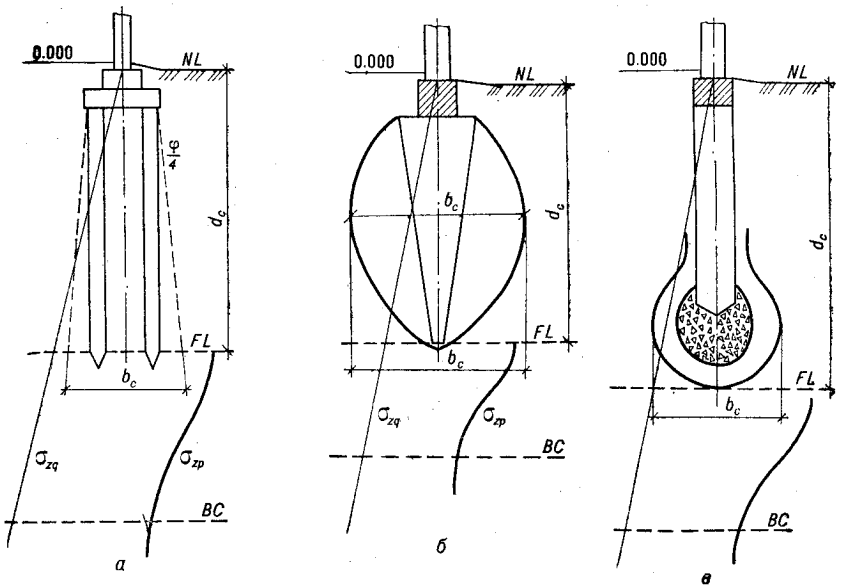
Схеми для розрахунку осідання фундаментів:
